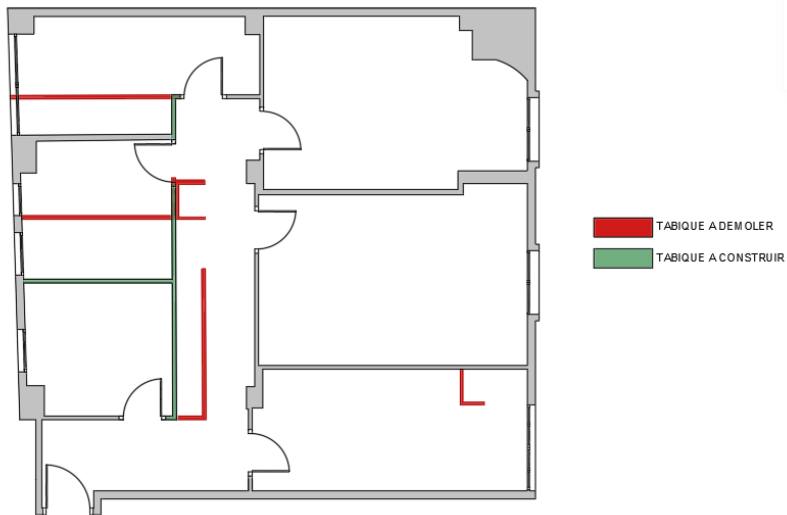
Plano de los tabiques a demoler y construir. Fuente propia
